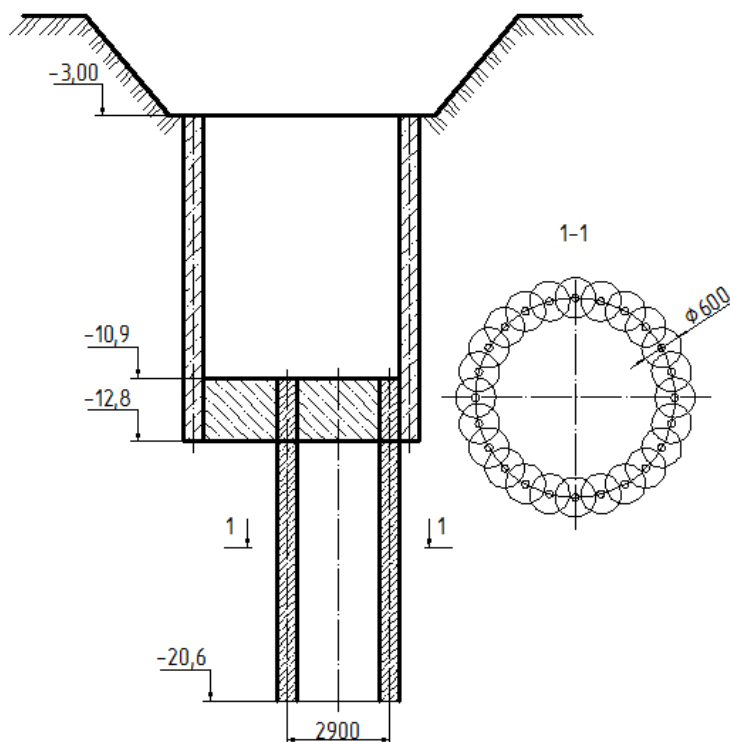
Ограждающая конструкция из грунтоцементных свай
